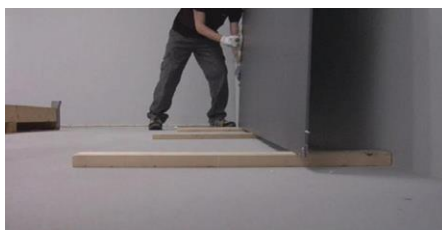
Alternativa para armazenamento é o apoio das placas sobre 4 sarrafos igualmente espaçados.
